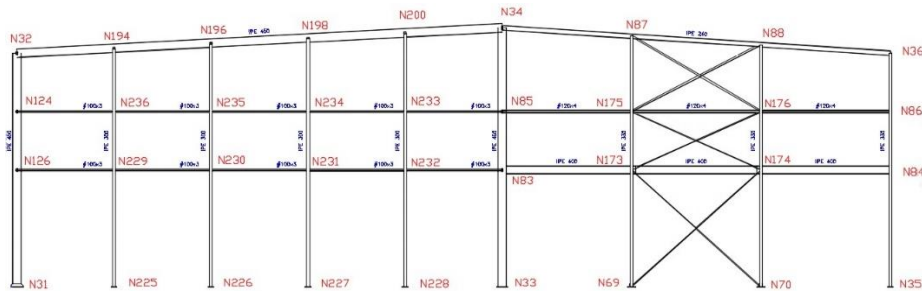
Pórtico Fachada F. (Fuente: Creación propia)
